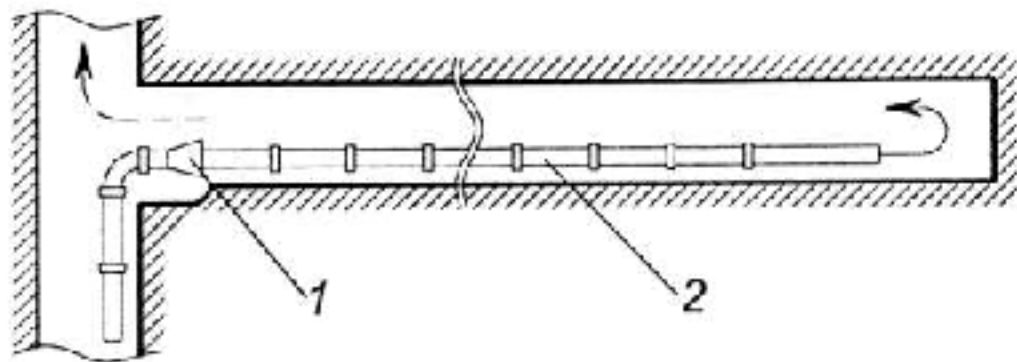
Схема нагнетального провітрювання тупикової виробки: 1 - нагнітальний вентилятор; 2 - нагнітальний трубопровід.
